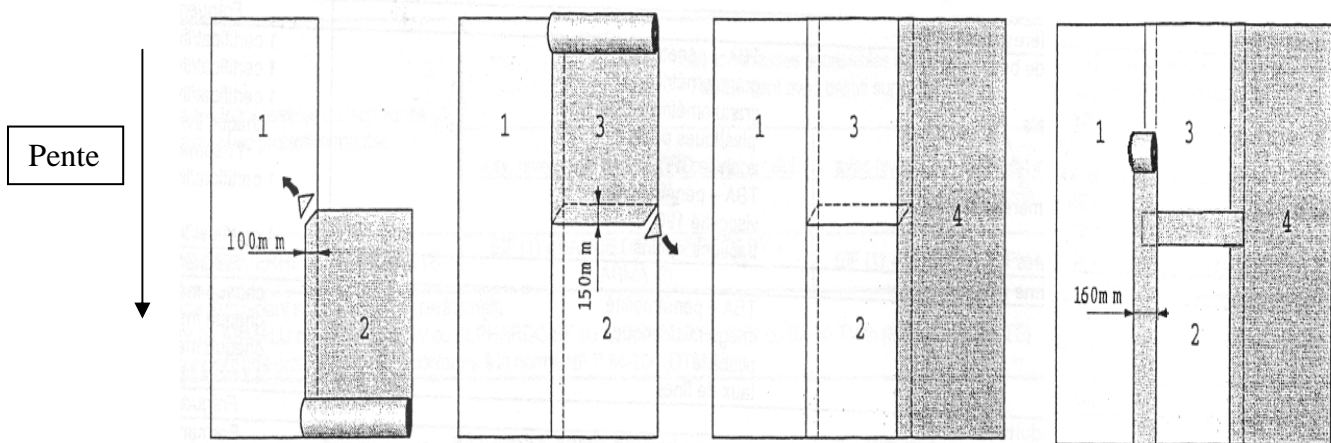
Soudure de l'about de lé sur PSE
